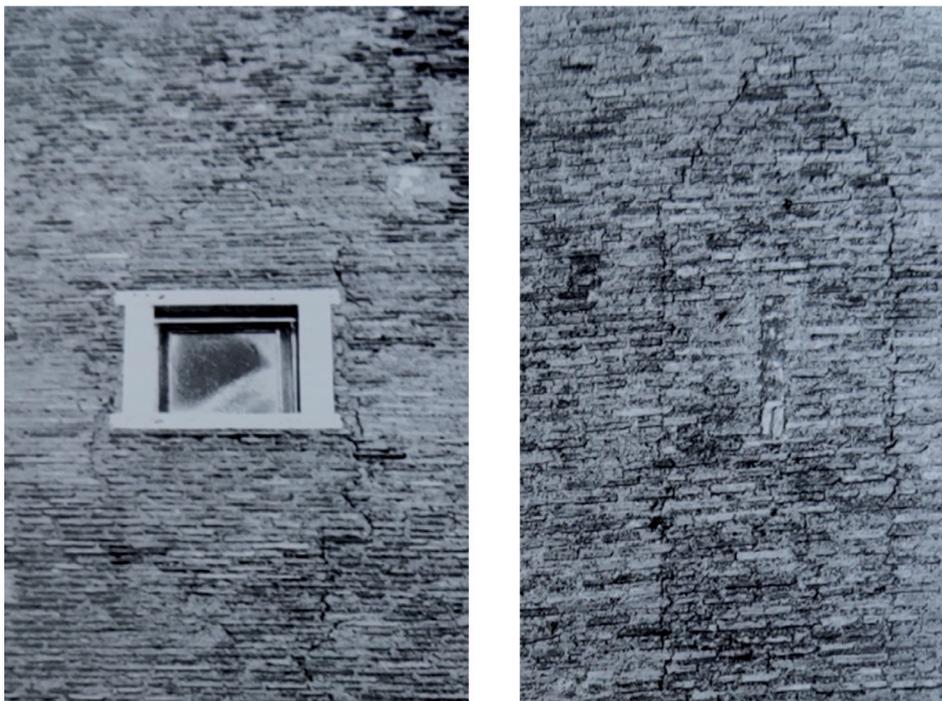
Finestra a capanna poi tamponata nel prospetto sud-ovest; finestra a capanna tamponata, con all'interno una feritoia anch'essa poi tamponata nel prospetto sud-est (da Bianchi, «La Torre»).
